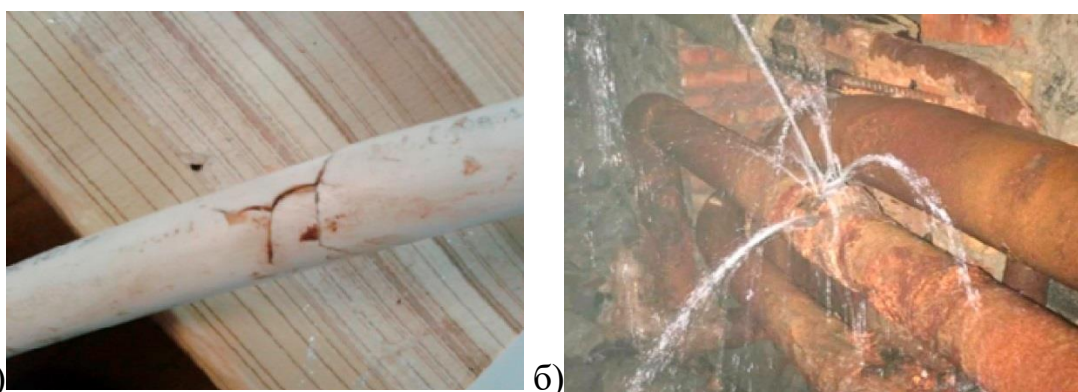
Аварии на водопроводной сети: а) трещина на трубопроводе; б) протечка трубопровода в стыке труб
